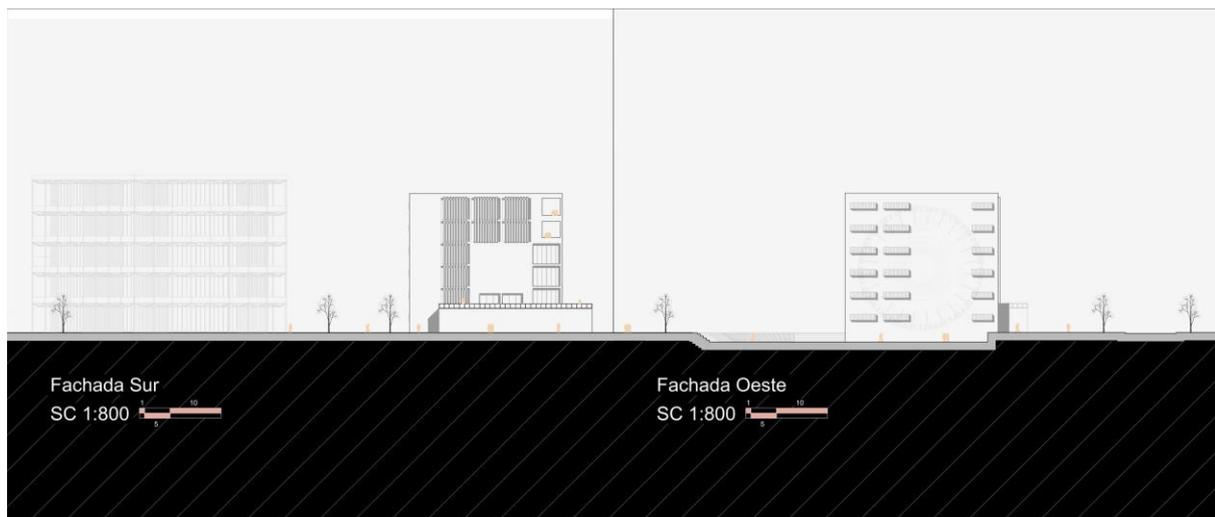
Est. Fachadas Sur & Oeste. Elaboración Propia
